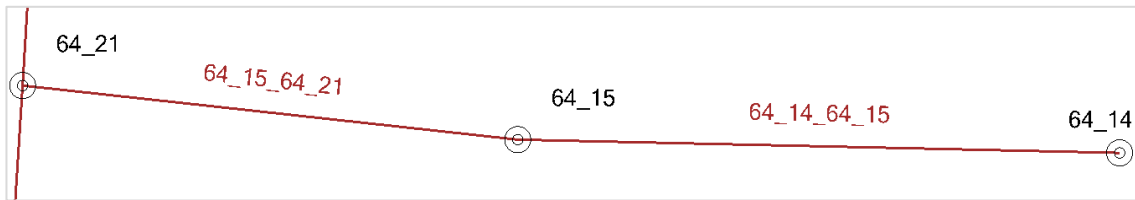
Caso de estudio 1 - Planta de la red entre los pozos 64_14 y 64_21
